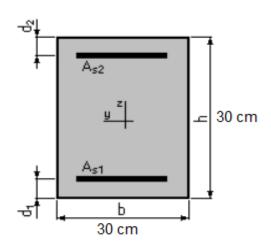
PREDIMMENSIONNEMENT D'UN POTEAU
